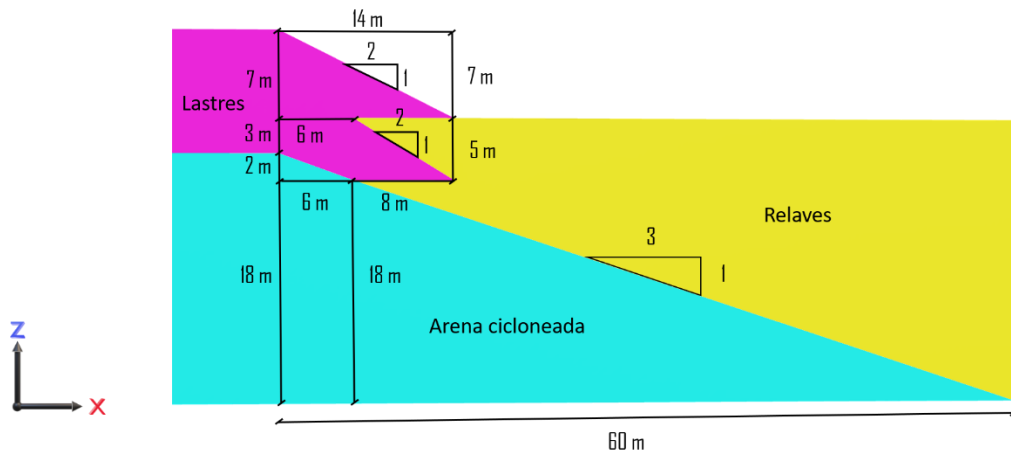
Detalle del perfil transversal del muro aguas arriba.
